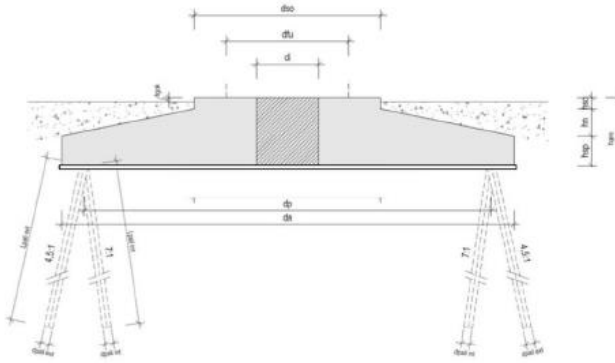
Andamento geometrico della fondazione (sezione - non in scala).
